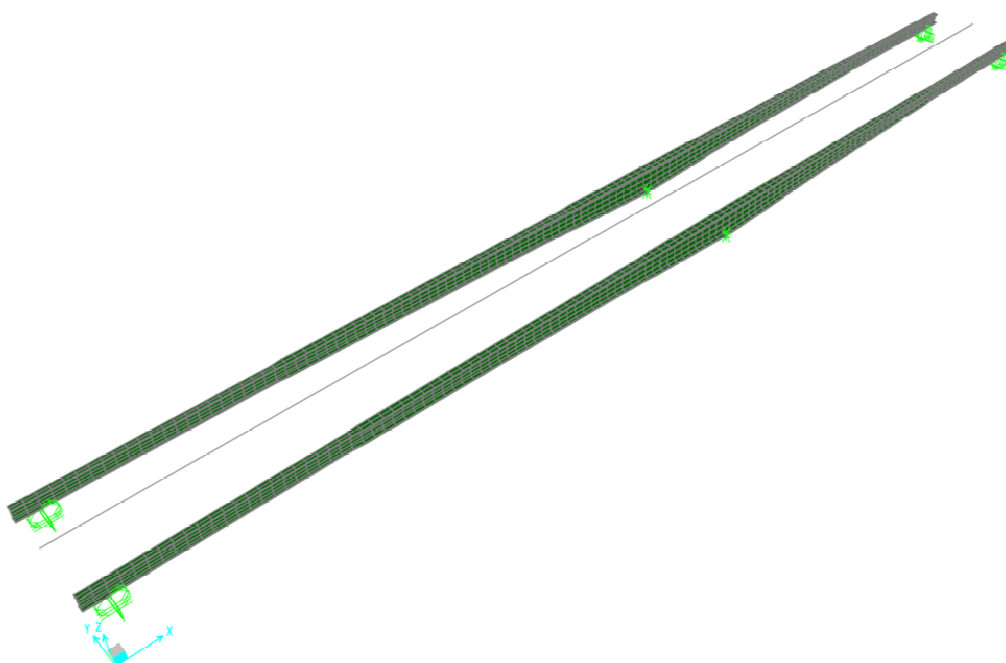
Modelo final das vigas metálicas longitudinais e respectivos apoios.
